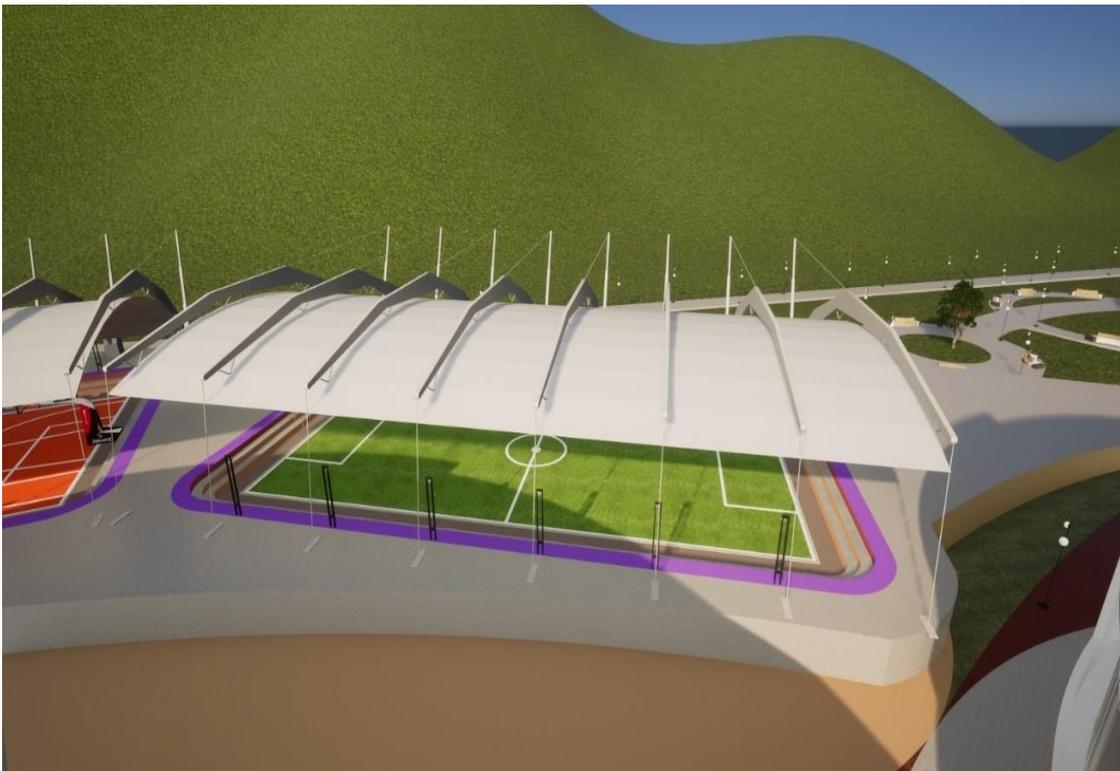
Vista 3d de la zona - losa deportivo techada con la integración al entorno. Fuente: elaboración propia
